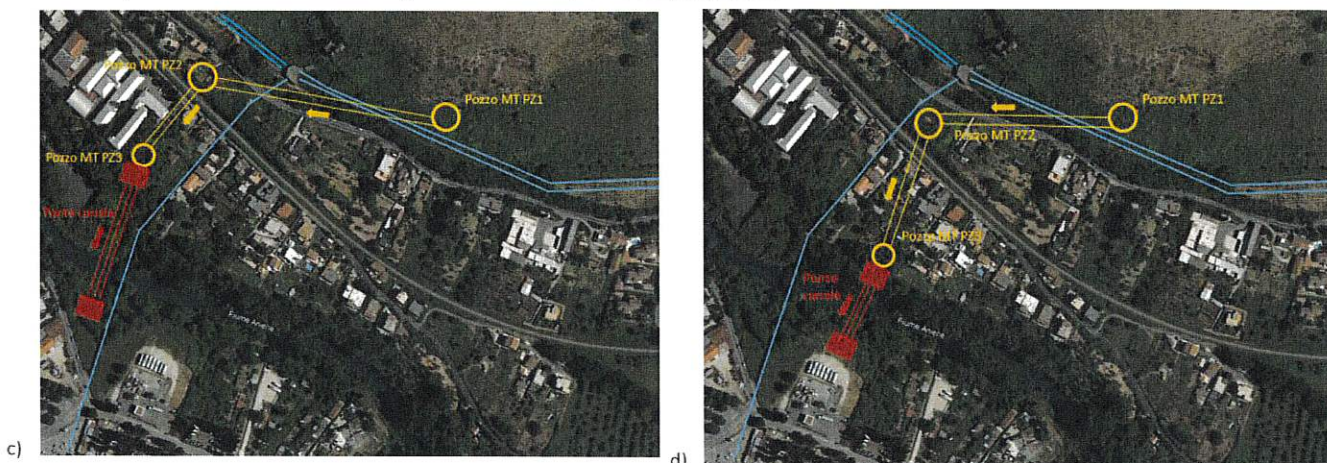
schemi delle alternative considerate estratte dall'allagato 1 al Riscontro del Proponente
